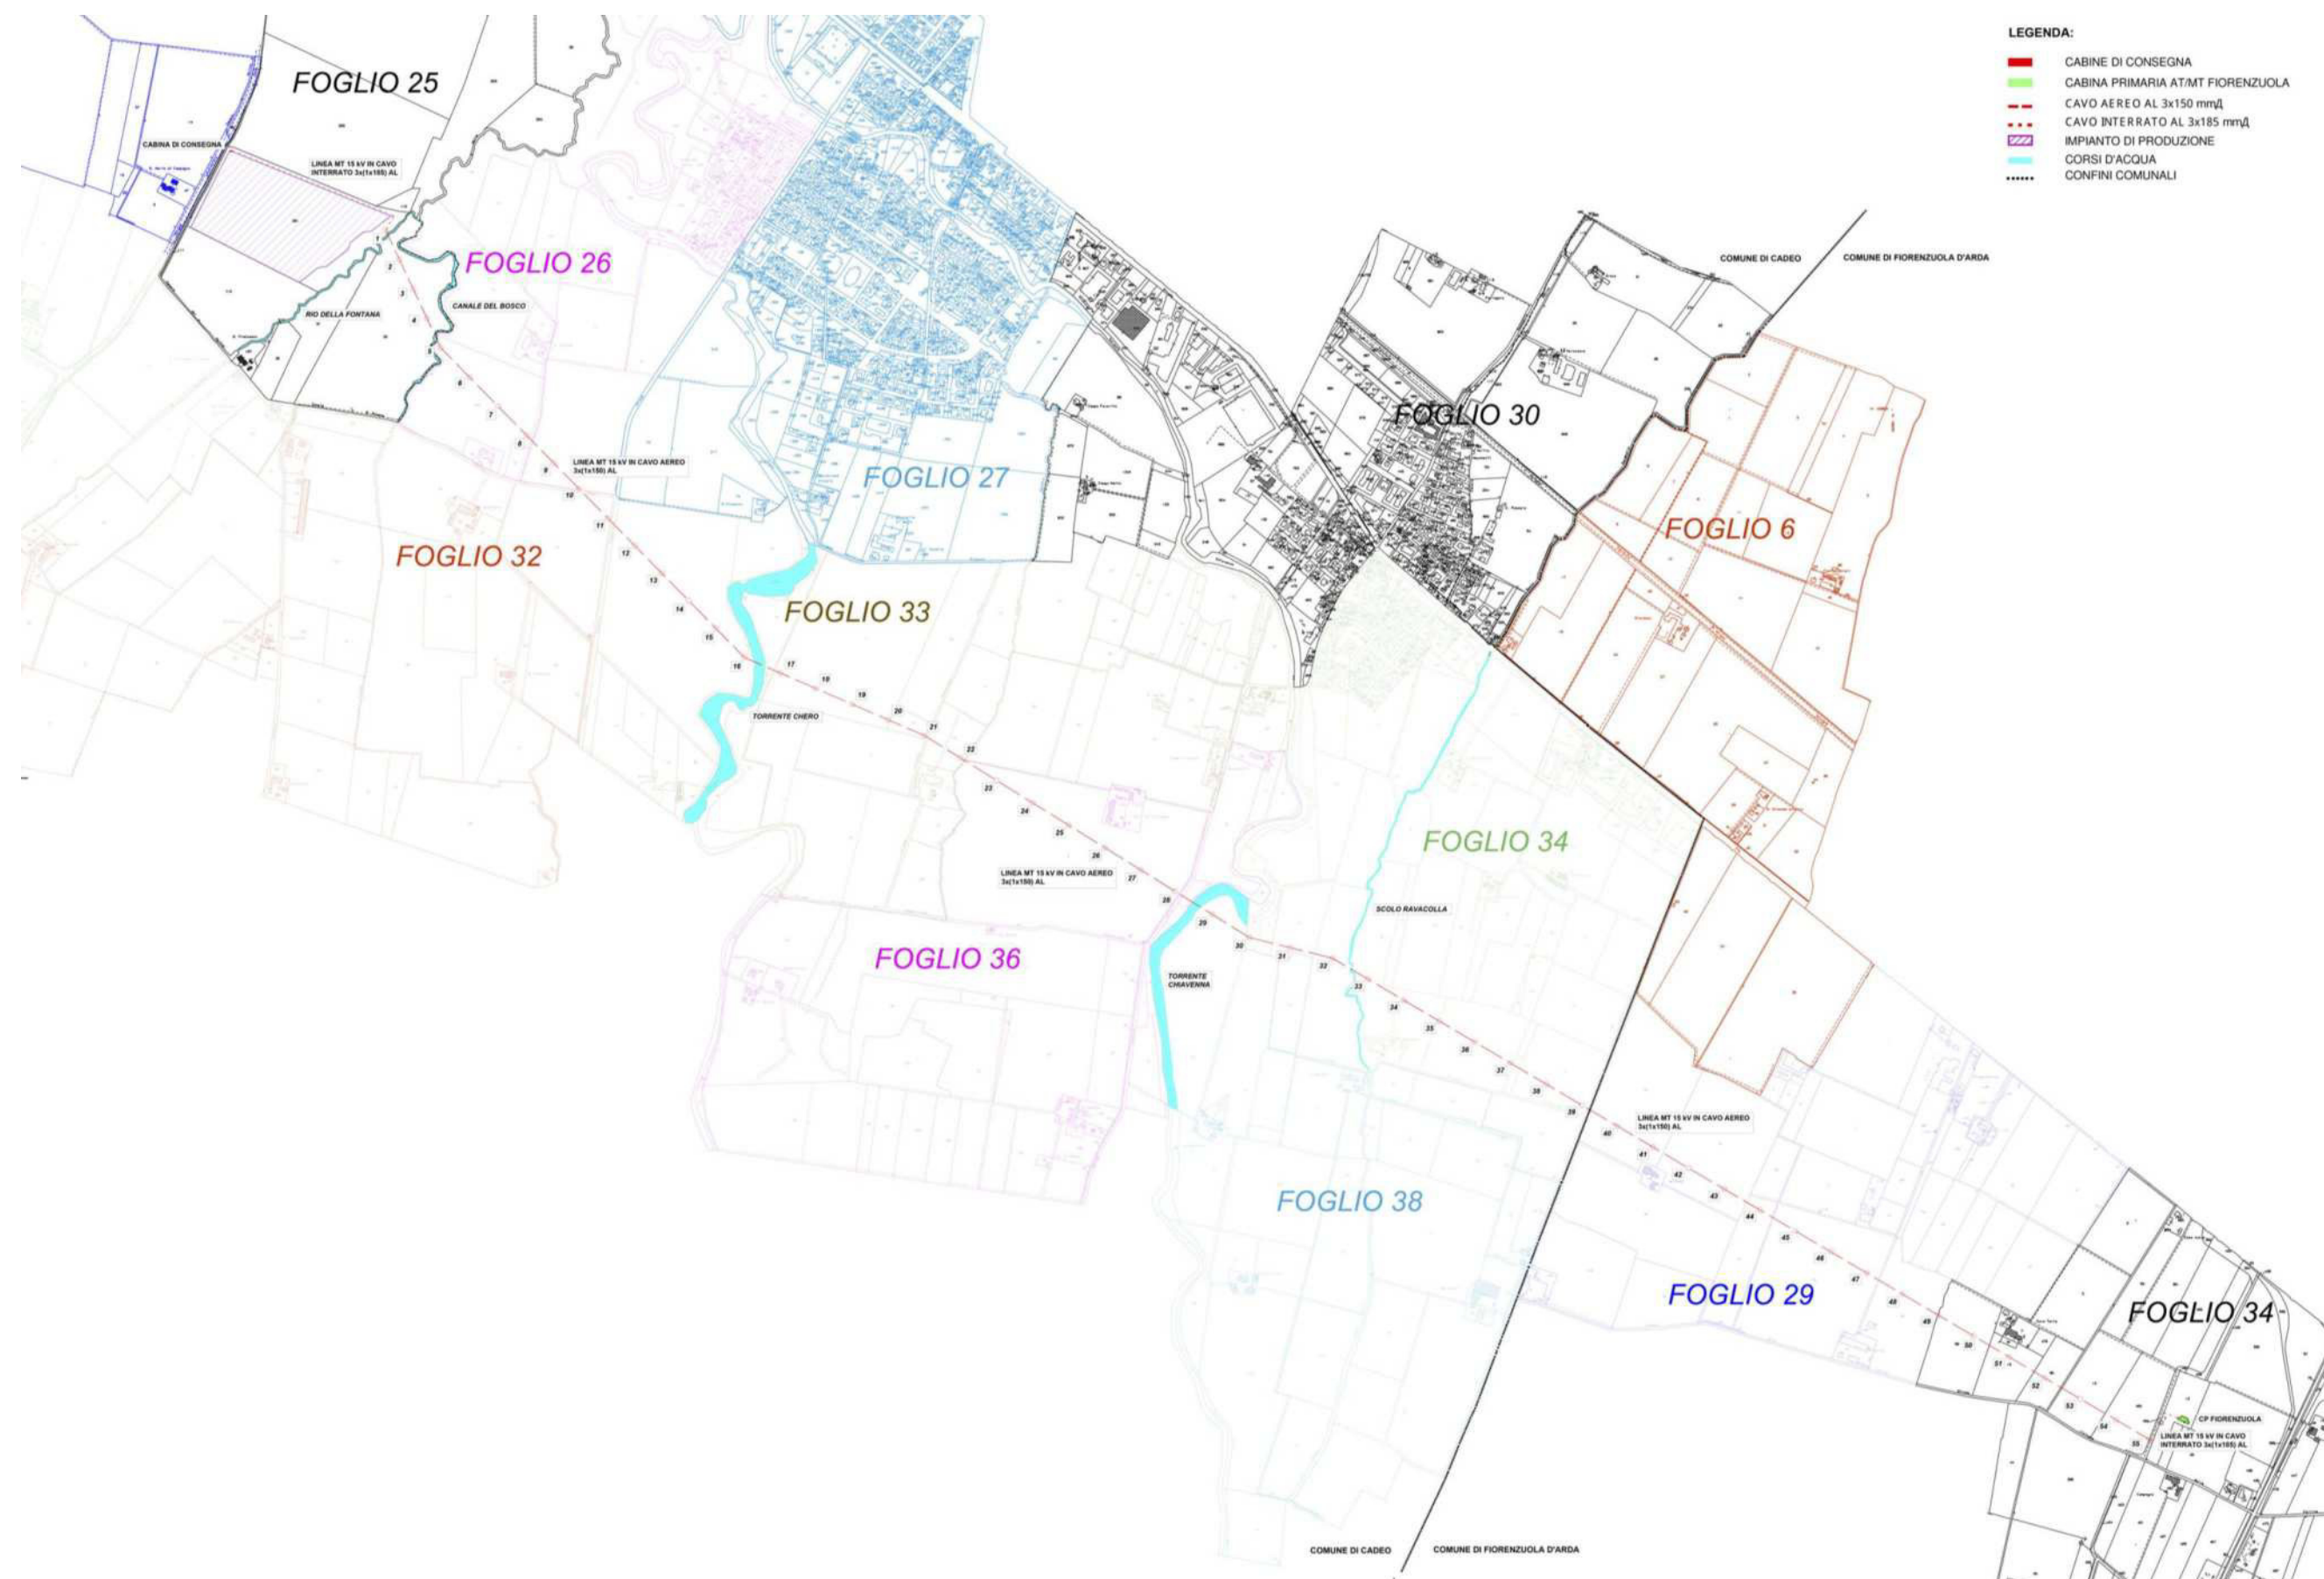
Stralcio della planimetria catastale del progetto per la connessione 15 kV.
